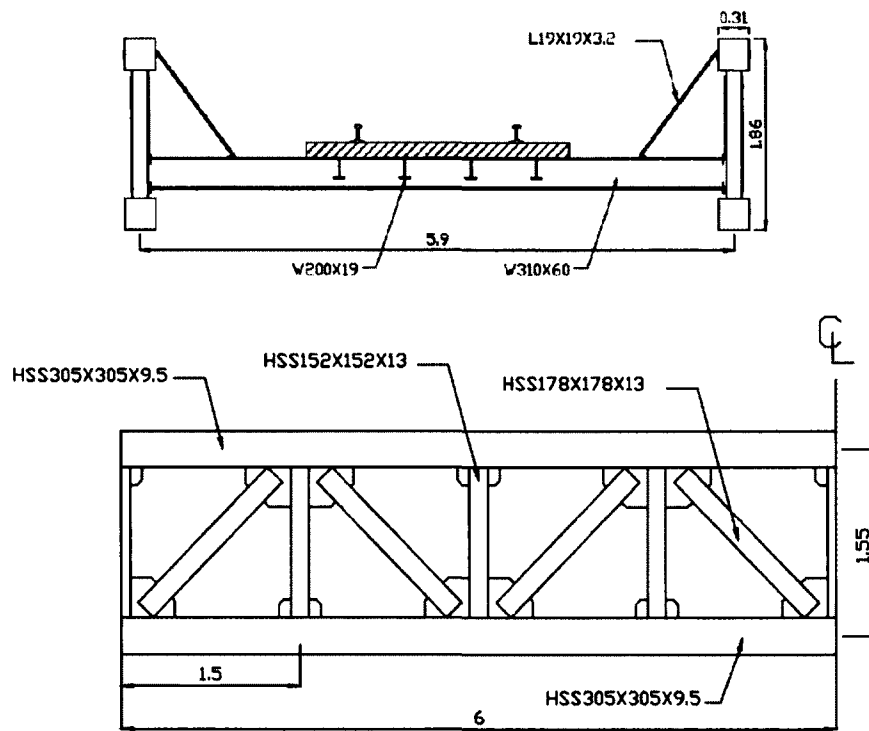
Pont à treillis latéraux - Section et élévation - Section A-A
